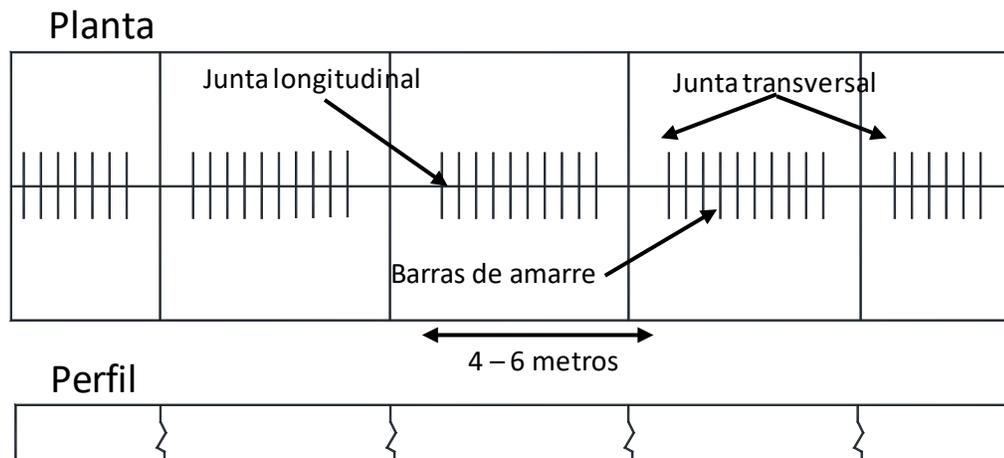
Pavimento de Concreto sin pasajuntas.(Elaboración propia).
